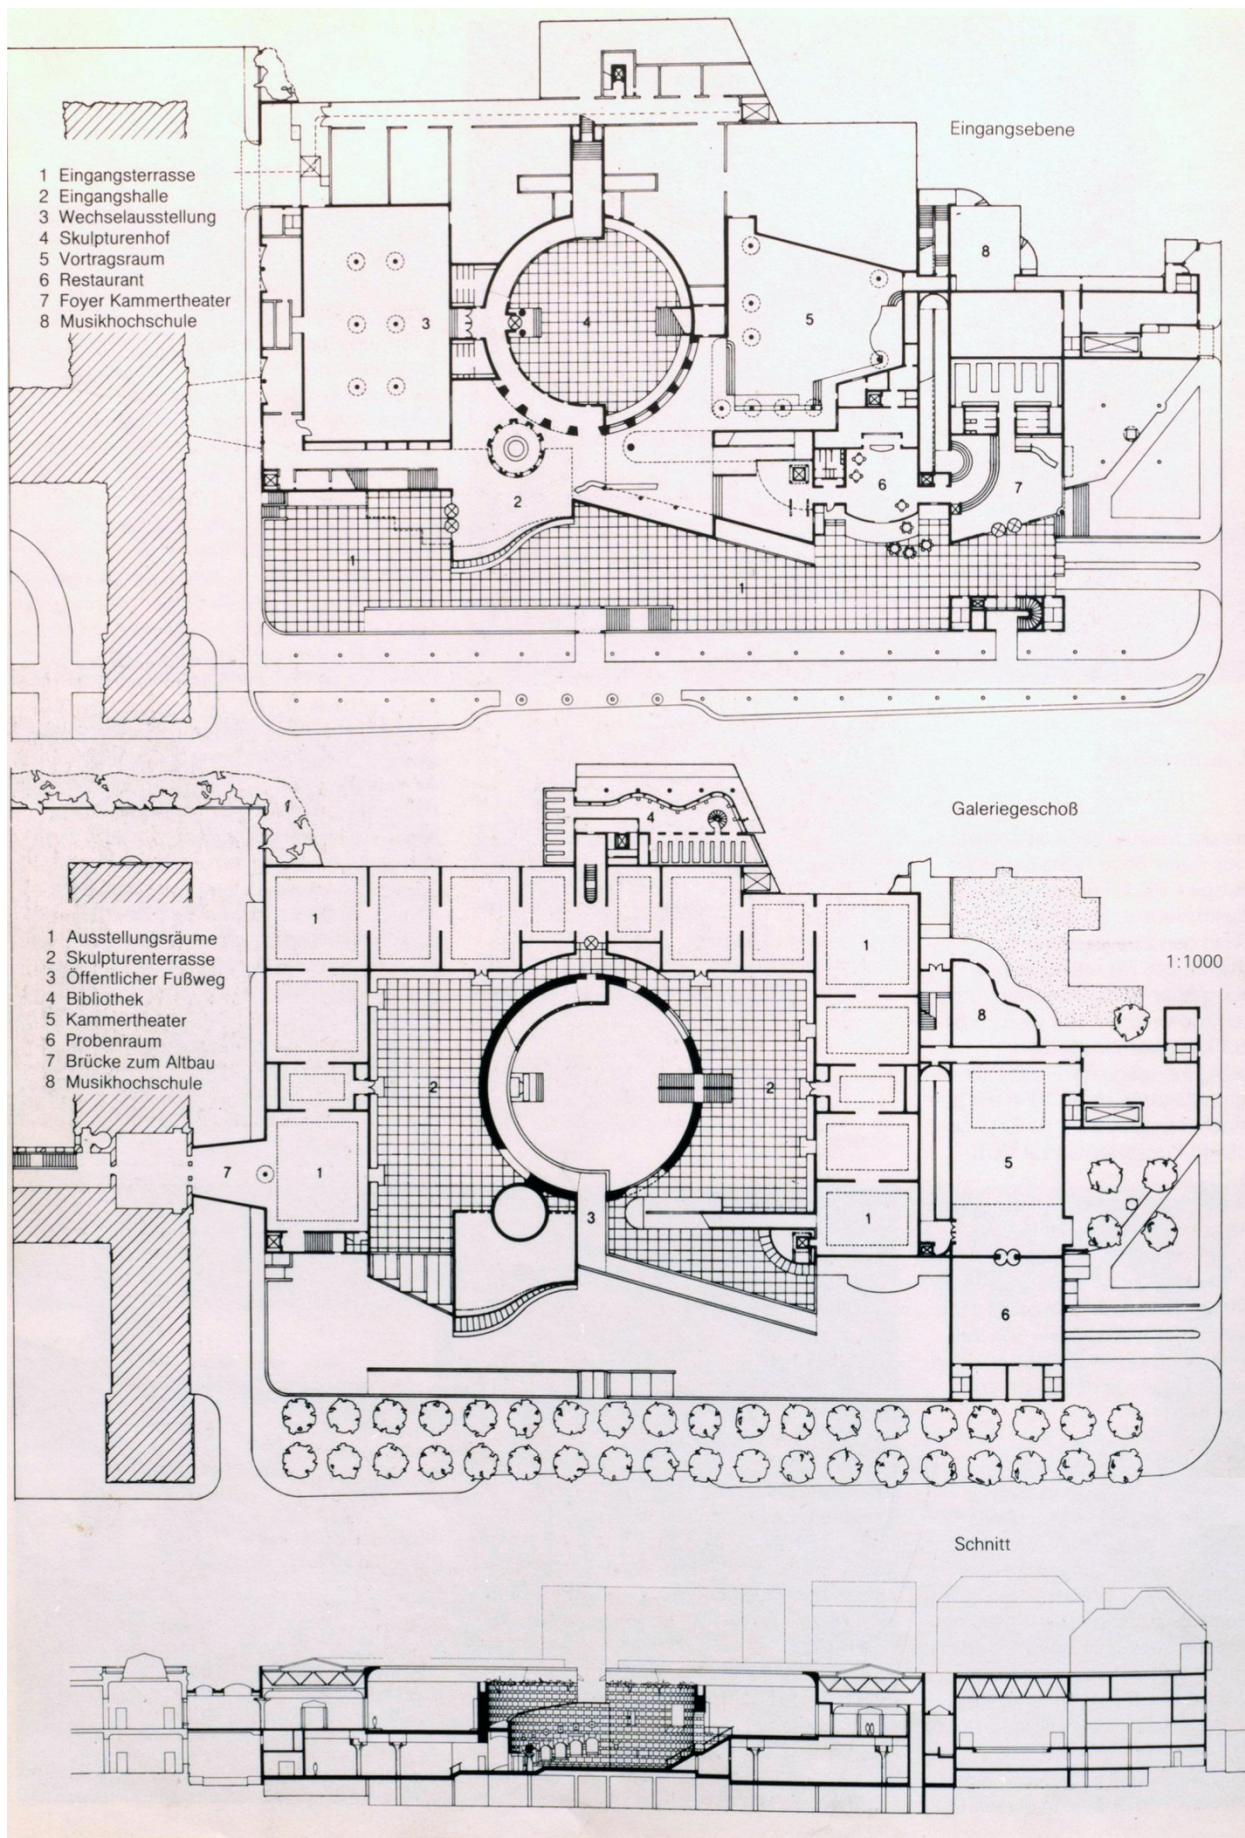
Grundrisse EG+OG sowie ein Längsschnitt *Neue Staatsgalerie*;
